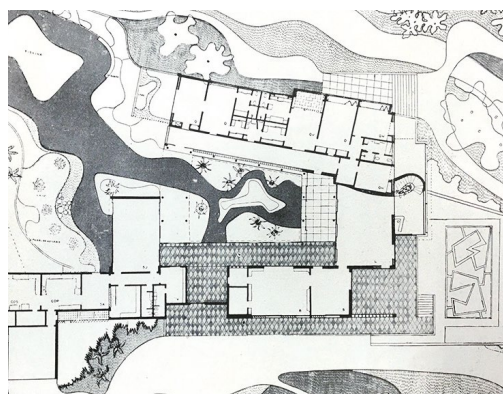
Planta baixa, pav. térreo.¹⁰
